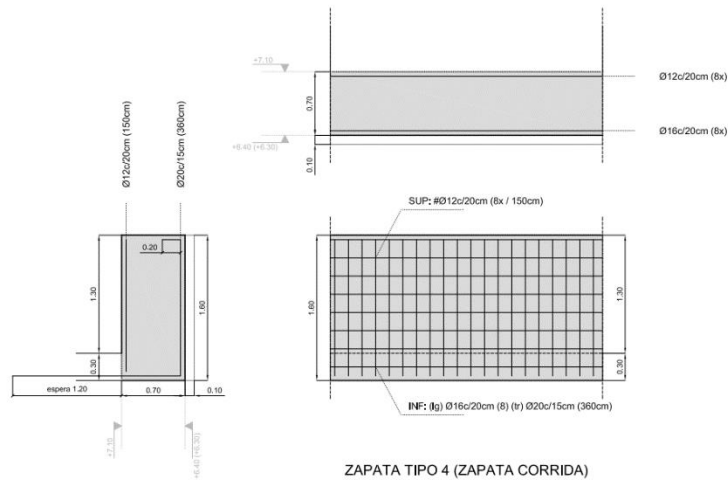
Armado zapata tipo 04. Fuente: David Gallardo.
